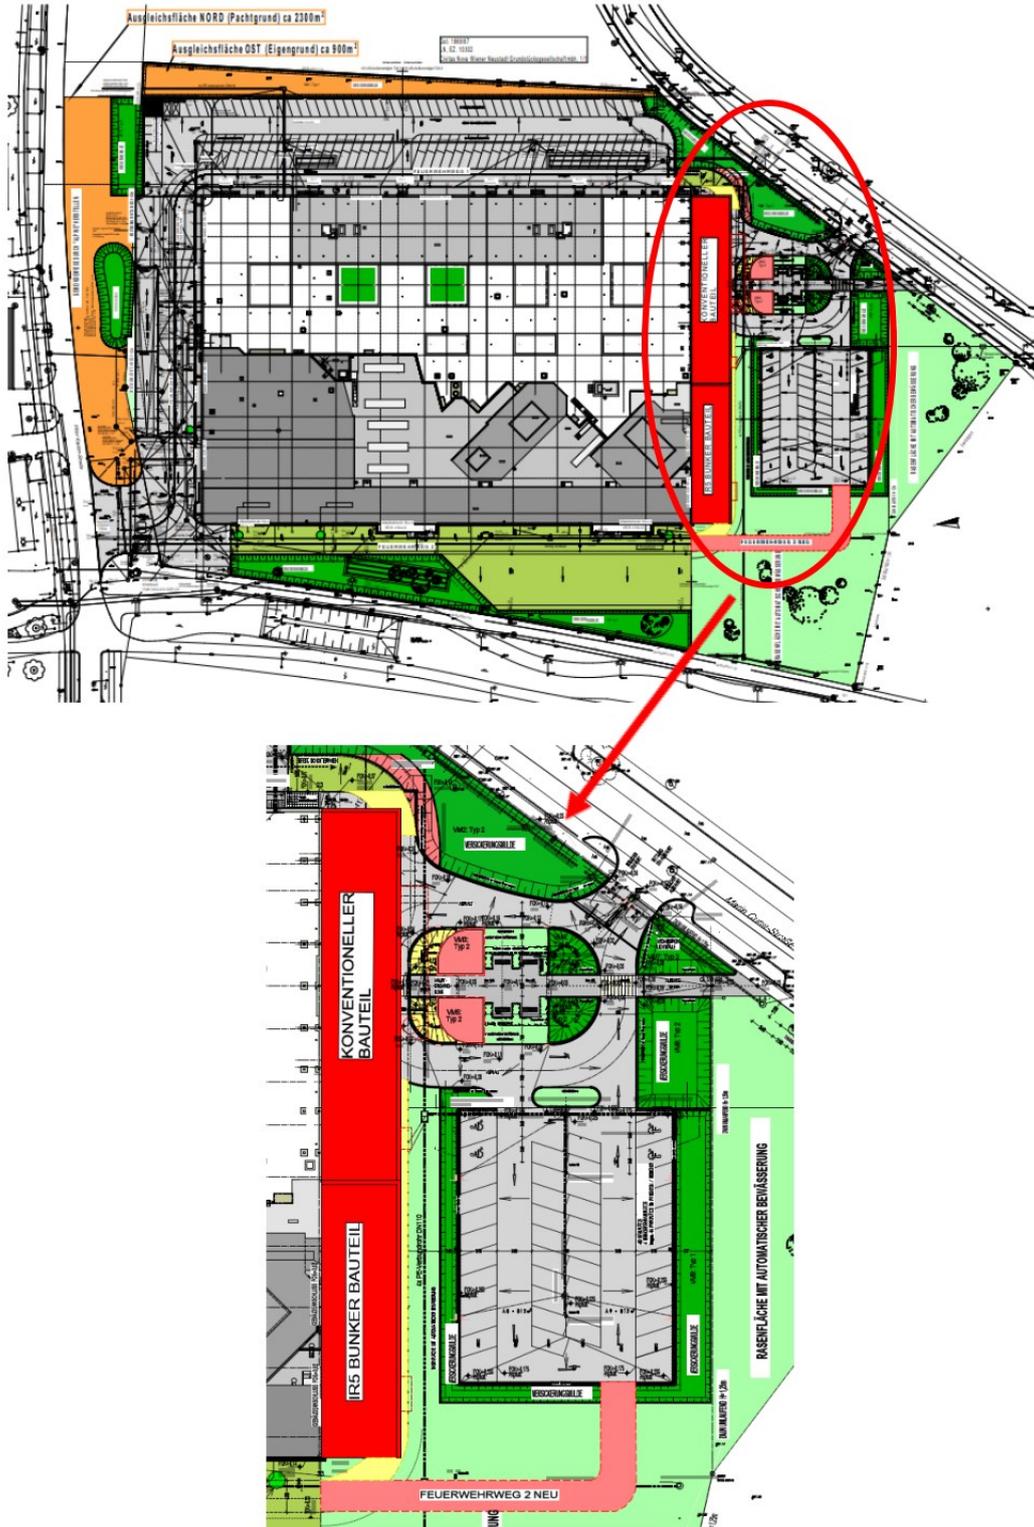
Bestehende Anlage MedAustron und Verortung des geplanten Zubaus mit den beiden Bauteilen farblich in Rot dargestellt. Details können dem Plan „B.03-01 P01 1.0 A Grundriss Erdgeschoss“ entnommen werden.
